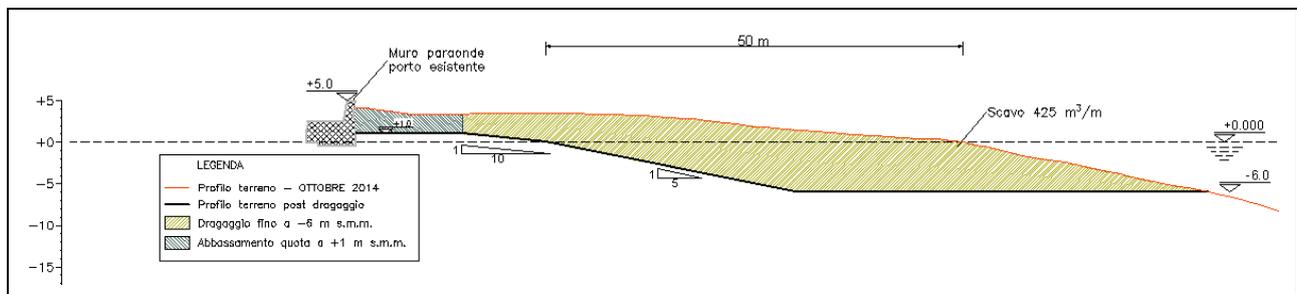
Sezione di dragaggio a ridosso del molo esistente (sezione Y-Y')
